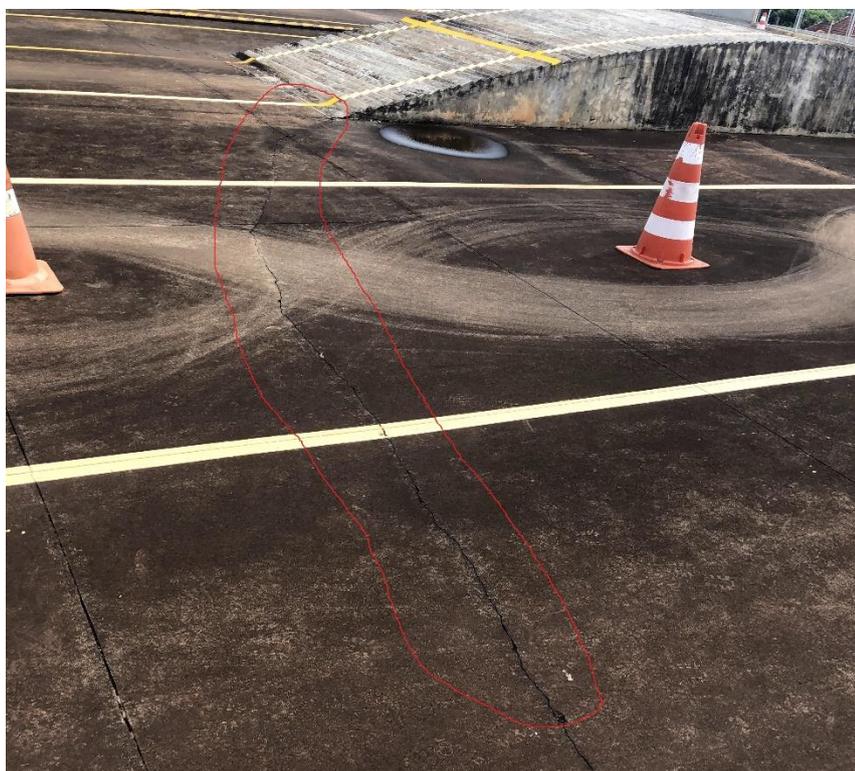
Exemplo de trinca em piso de concreto
